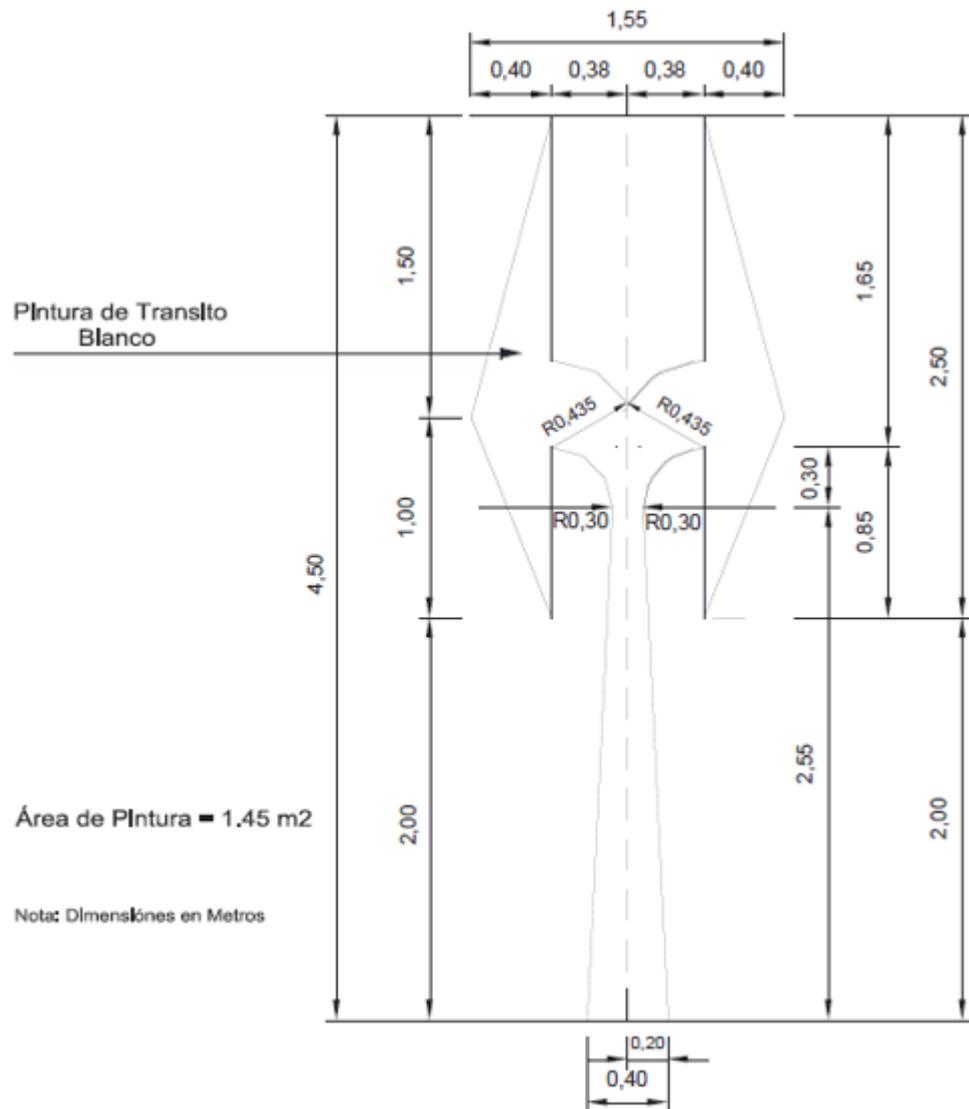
Símbolo Flecha de Giro a la Derecha e Izquierda.
